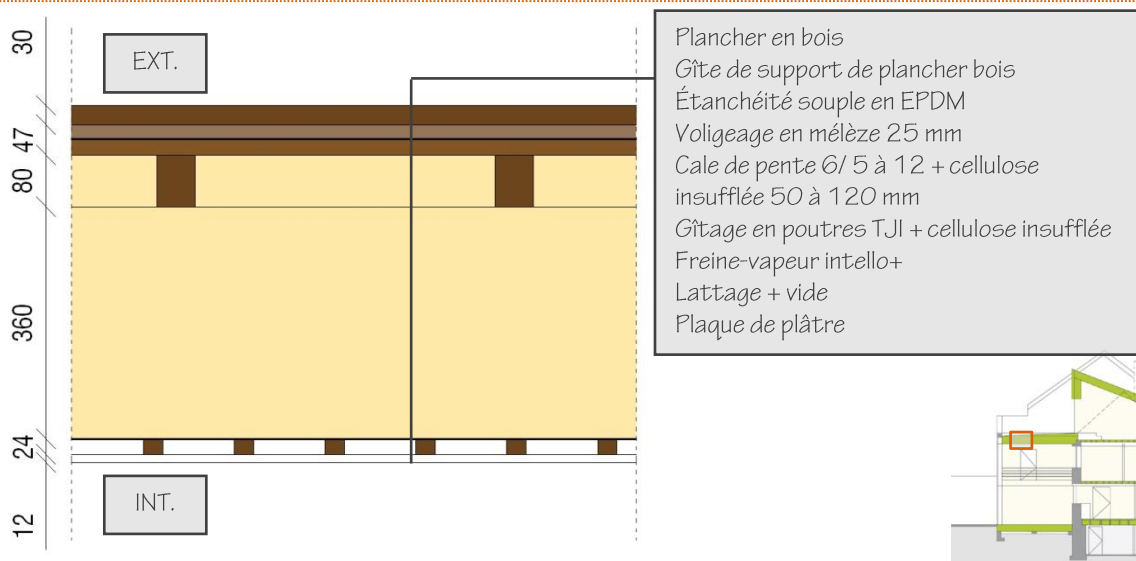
Détail du plancher de l'annexe, mesures en [mm]
